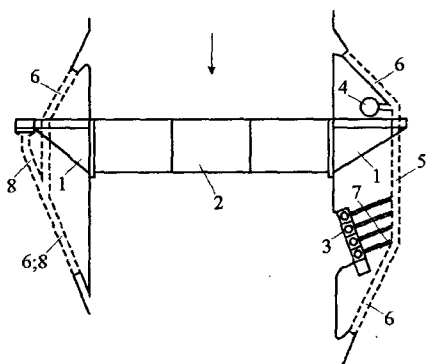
Схема компоновки гидроузла с водосливной плотиной из укатанного бетона и тоннельным эксплуатационным водосбросом:
